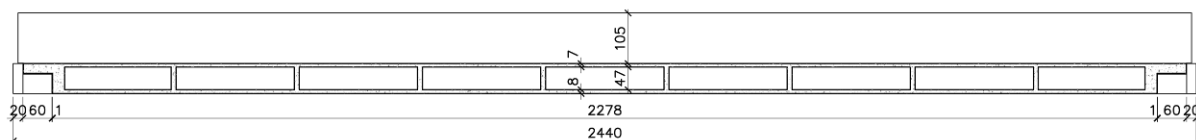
Projeto estrutural: corte longitudinal típico. Dimensões em (cm)
